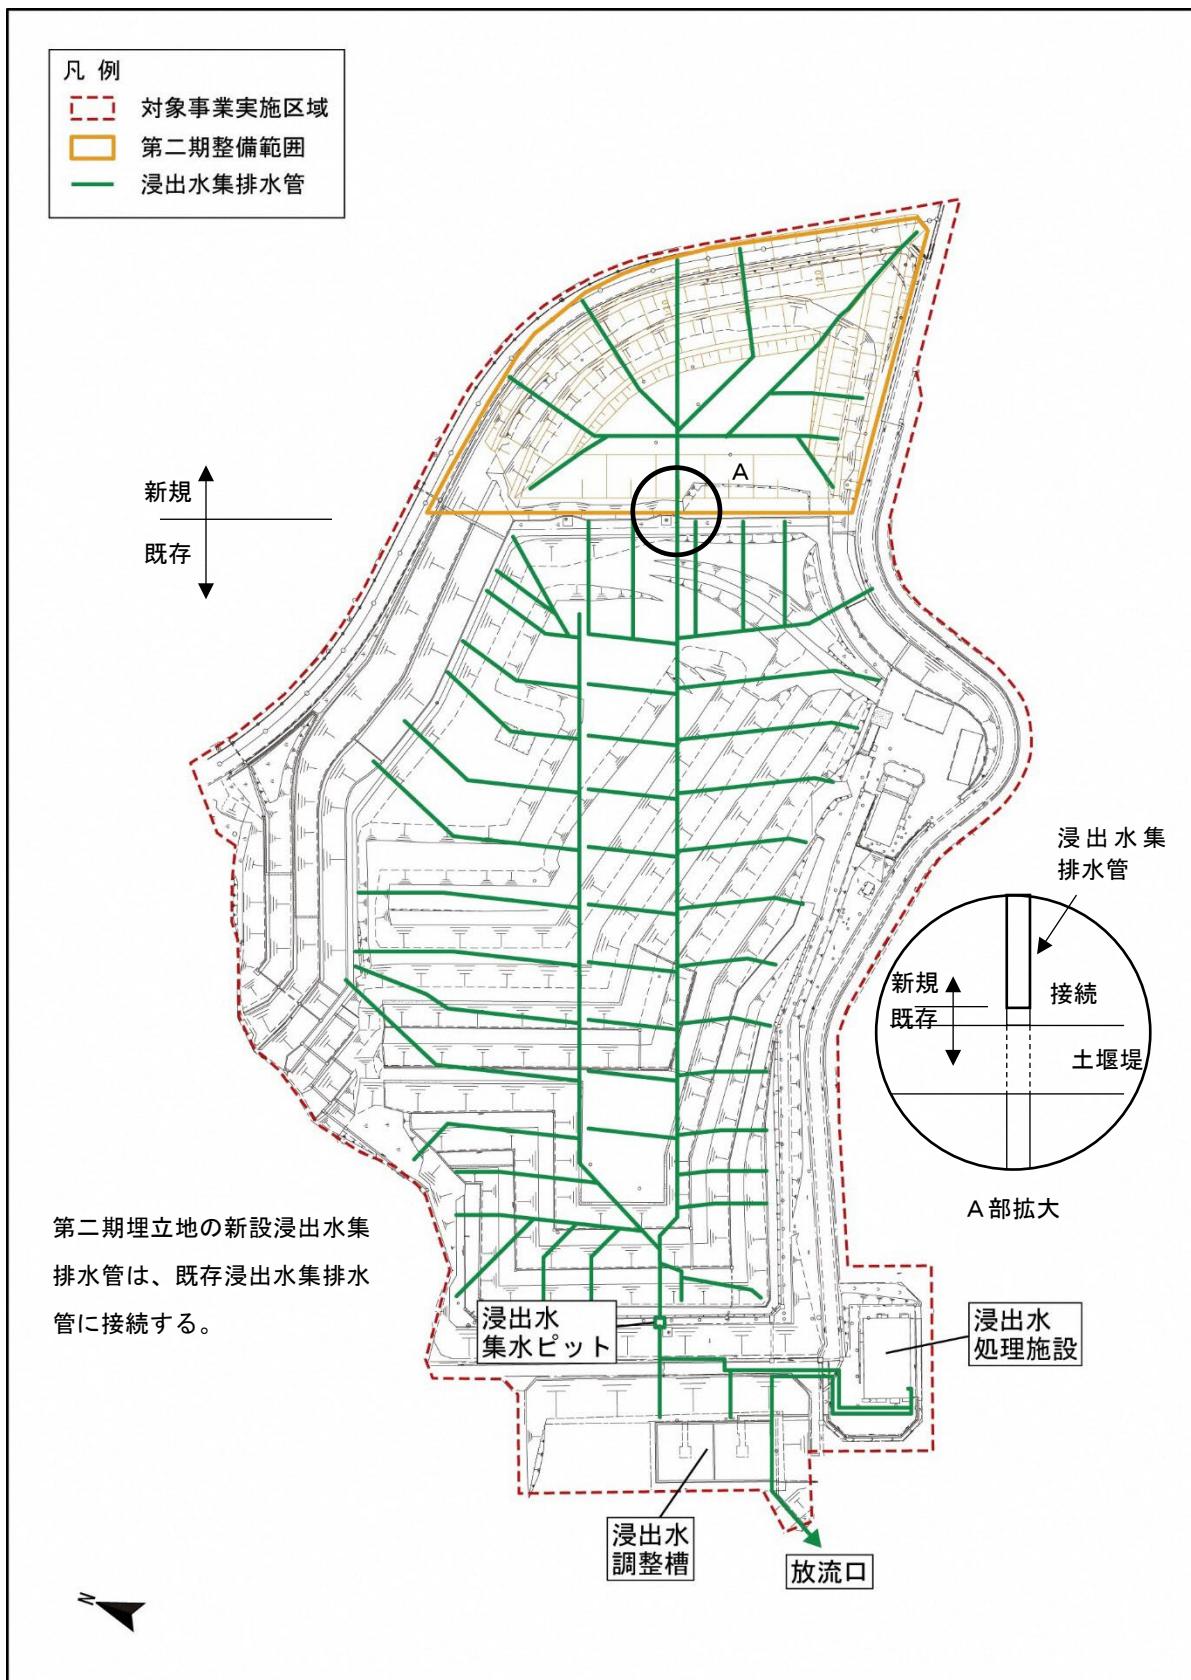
(1) 集排水設備計画平面図（浸出水集排水設備）
